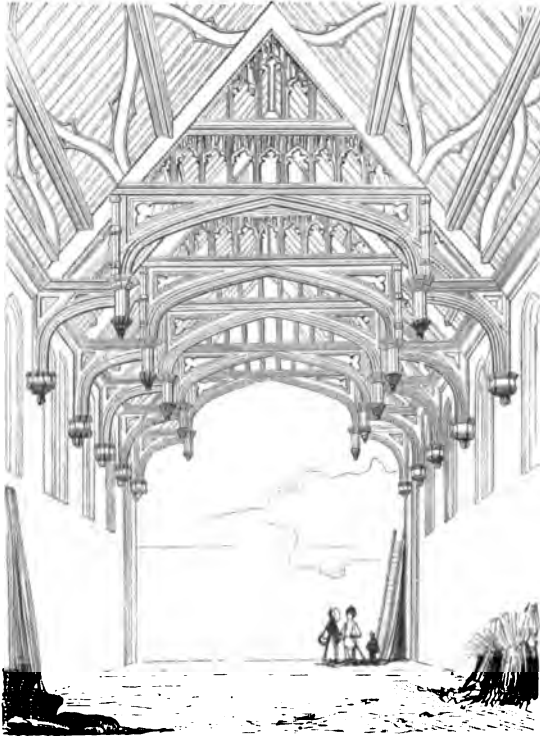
Halle im Schloß zu Eltham. (Fergusson.)
